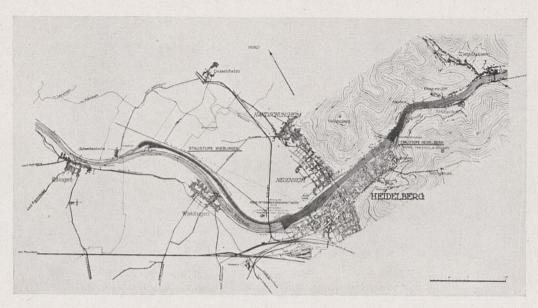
Lageplan der Staustufen Wieblingen und Heidelberg.
